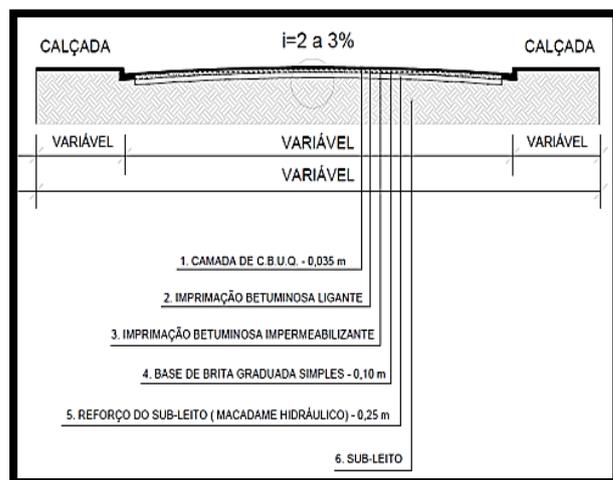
Estrutura do pavimento flexível. Fonte: Schneider, 2022¹³.
